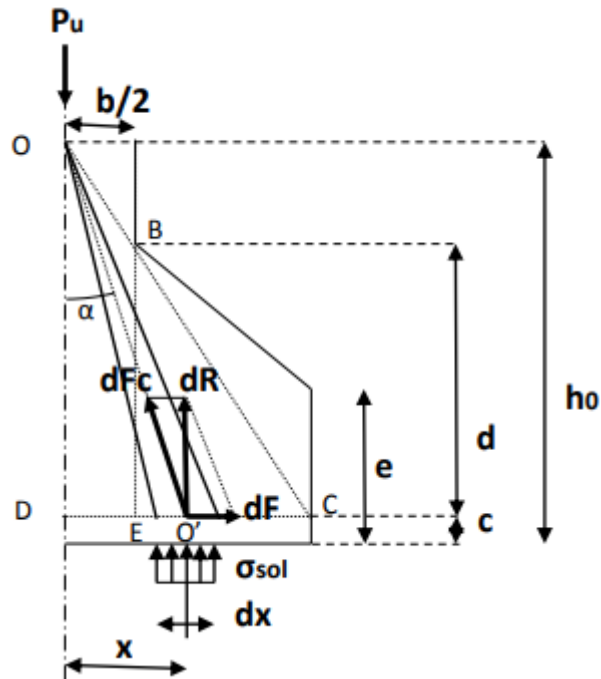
Éléments de ferrailage d'une semelle continue.
